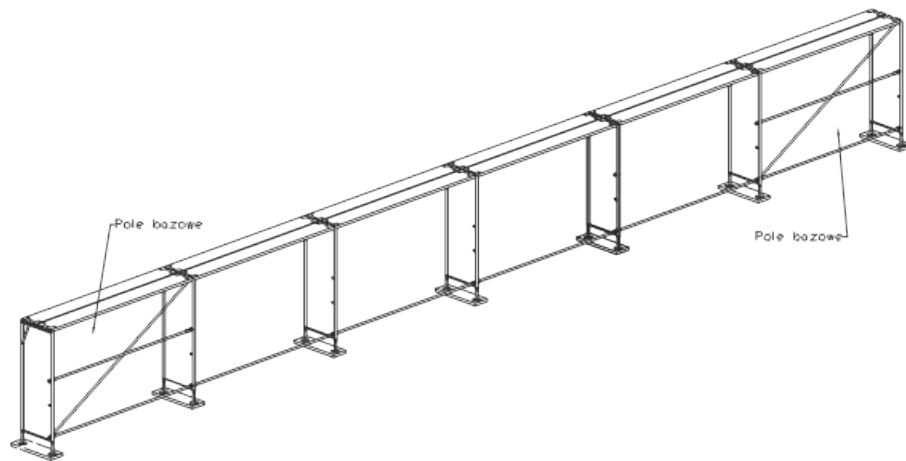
Zmontowane pole bazowe pierwszej kondygnacji
